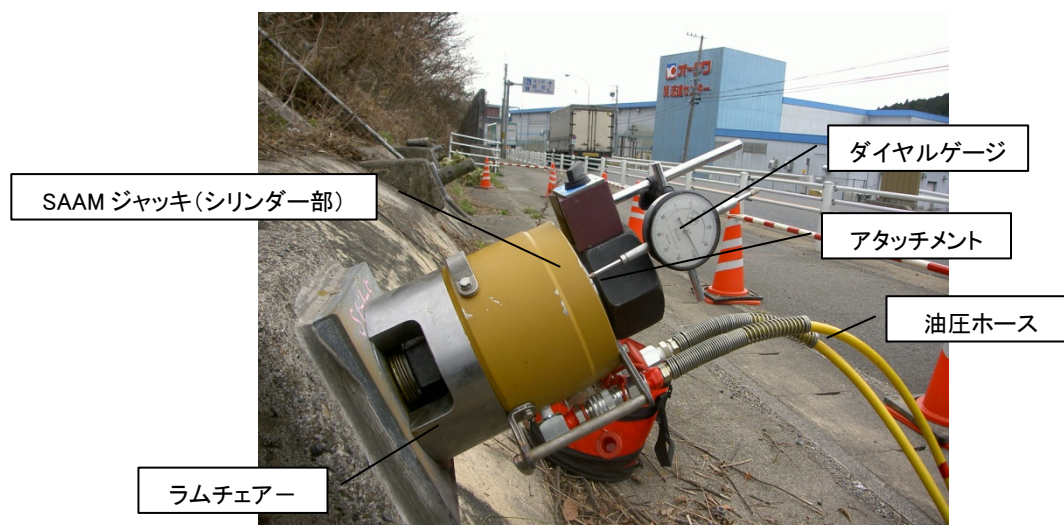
SAAM ジャッキ設置状況 (N タイプ)
